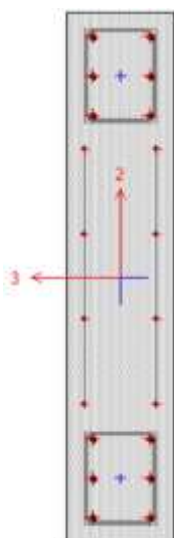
Concreto Armado, sección de placa P-1 (1.25x0.25)
